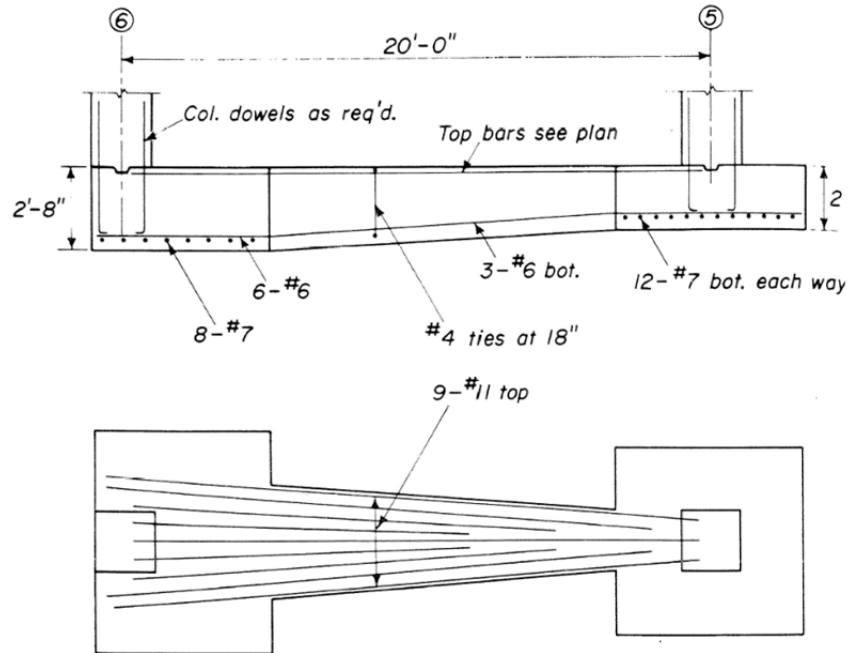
Patrón de armado zapatas aislada con viga riostra. Teng [10].
